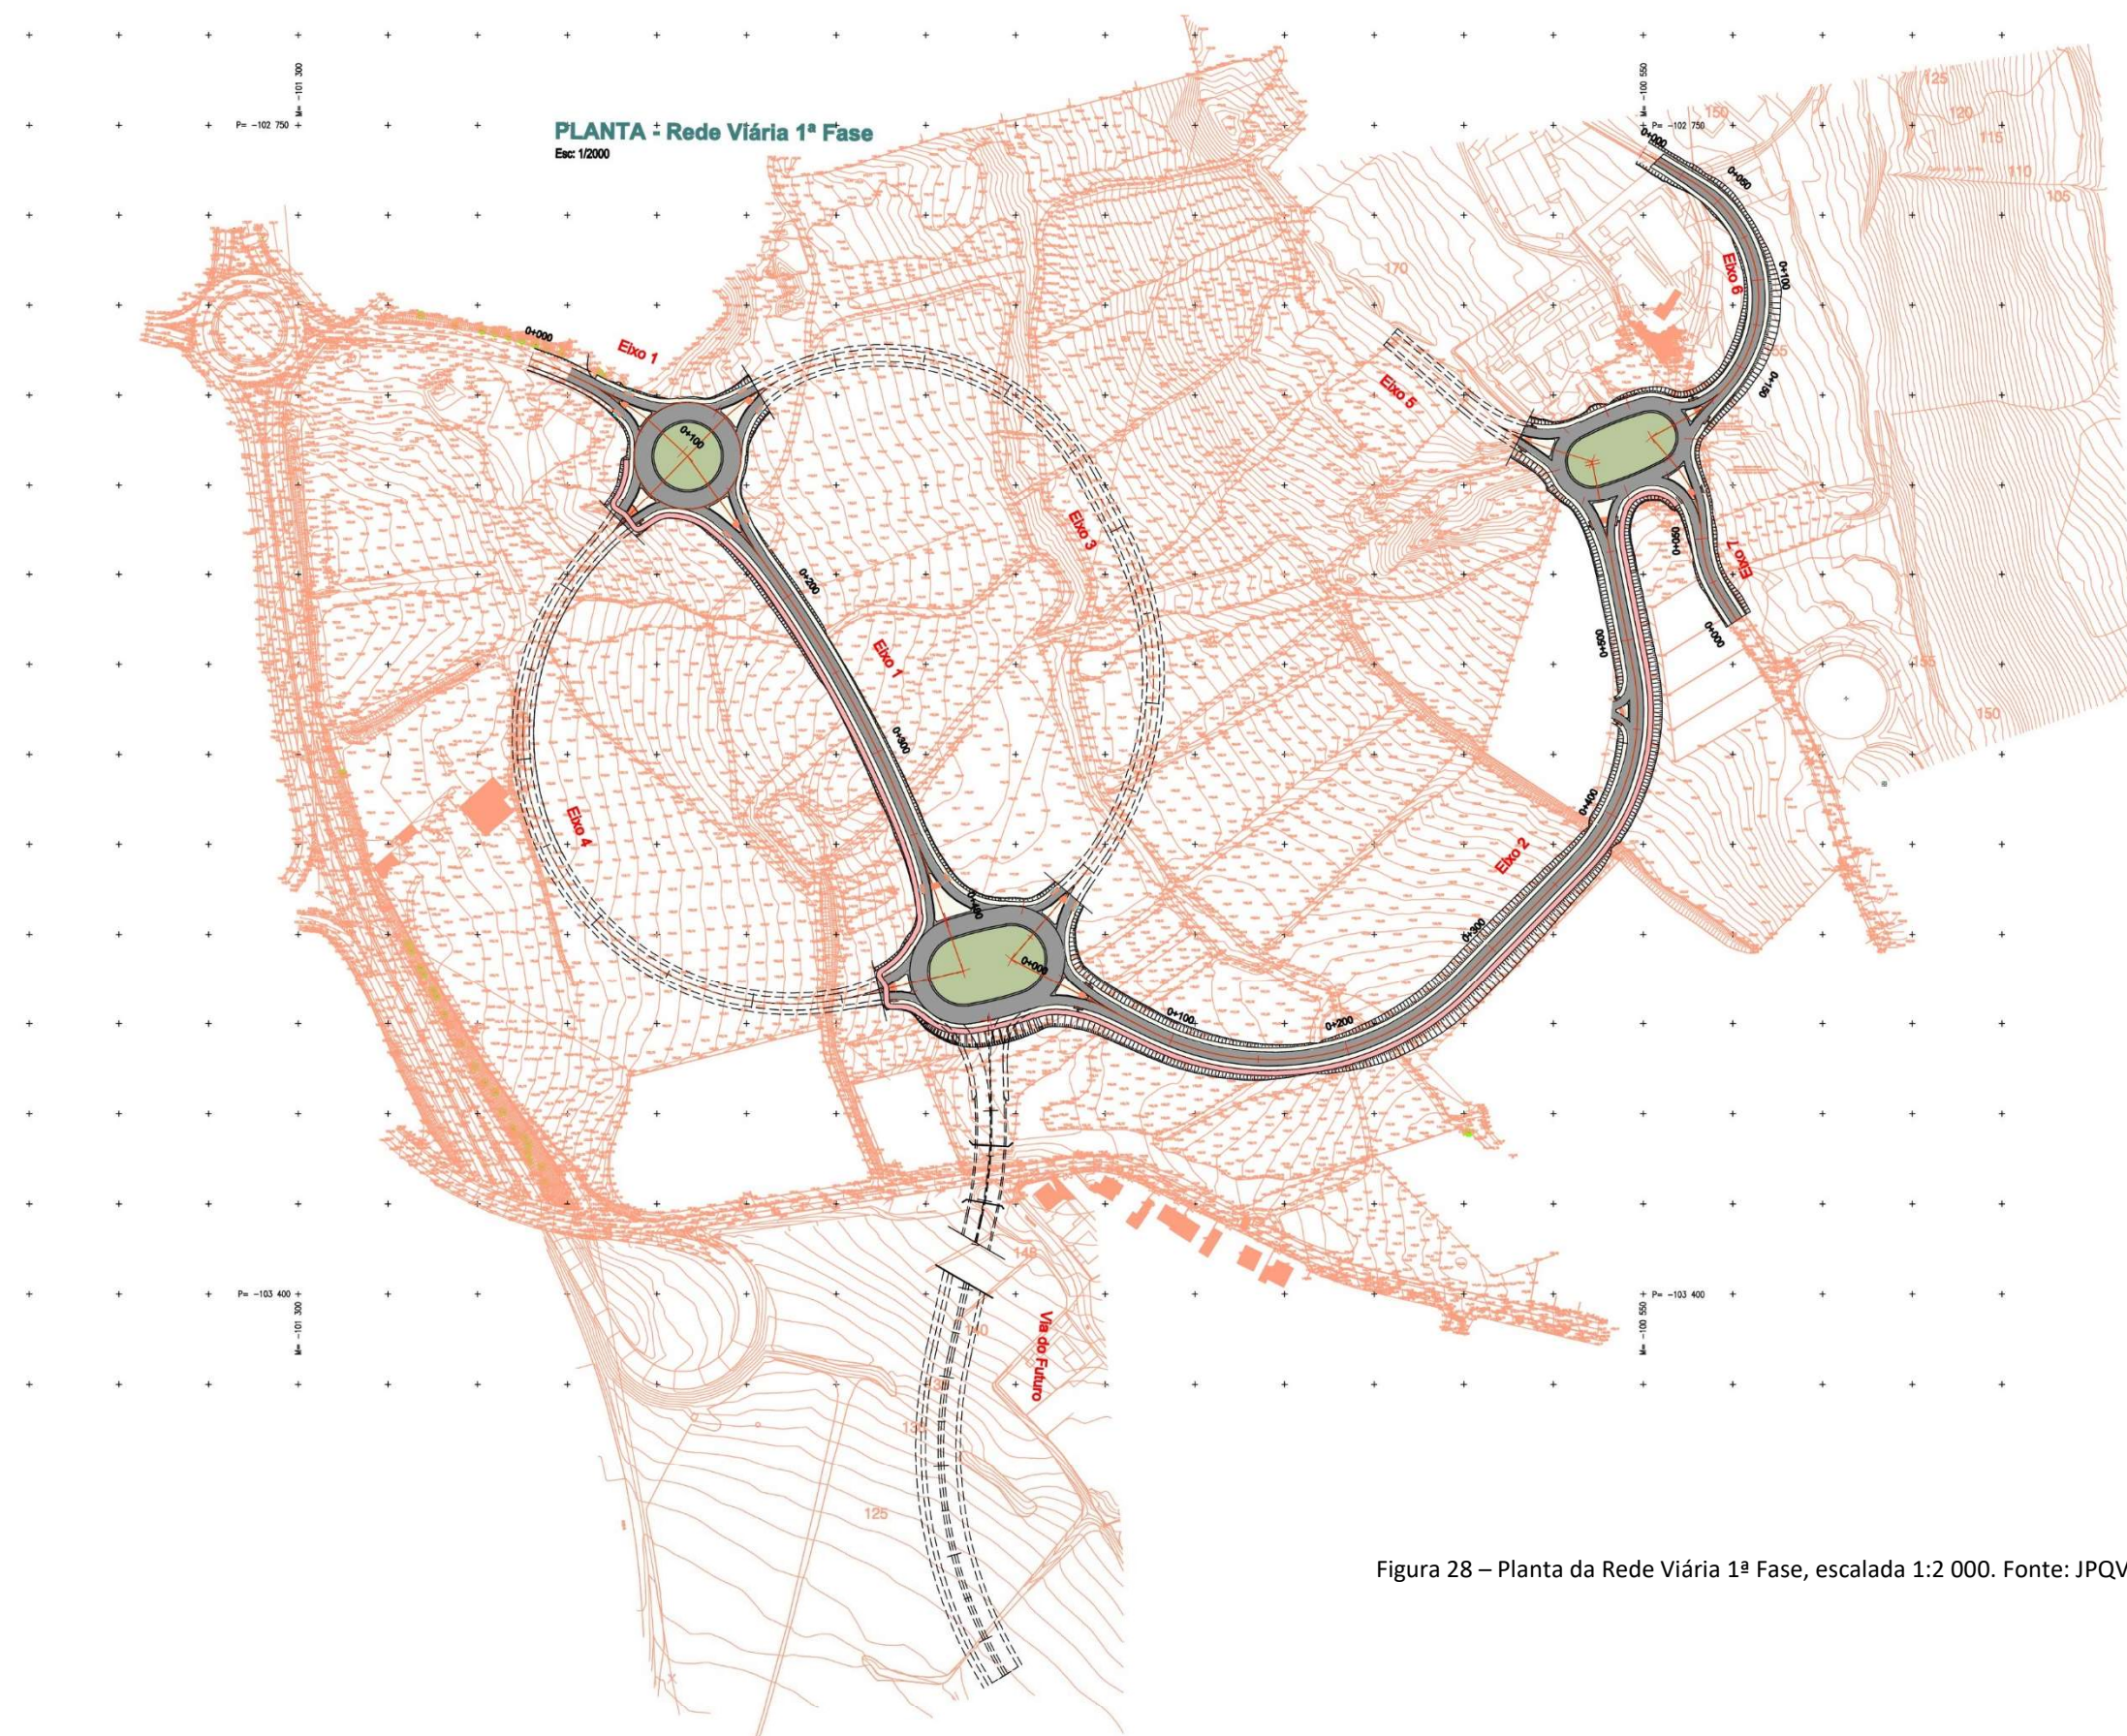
Planta da Rede Viária 1ª Fase, escalada 1:2 000. Fonte: JPQV 2021
